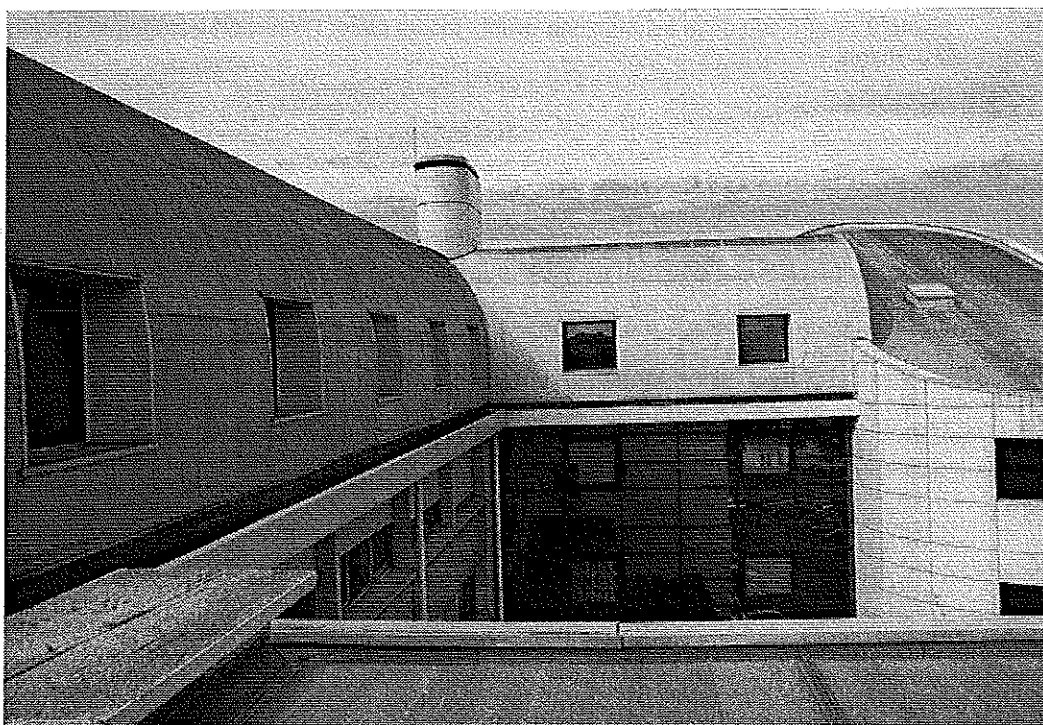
Vue partielle de la toiture (zone plate inclinée, zones cylindriques). © J. Putatti
